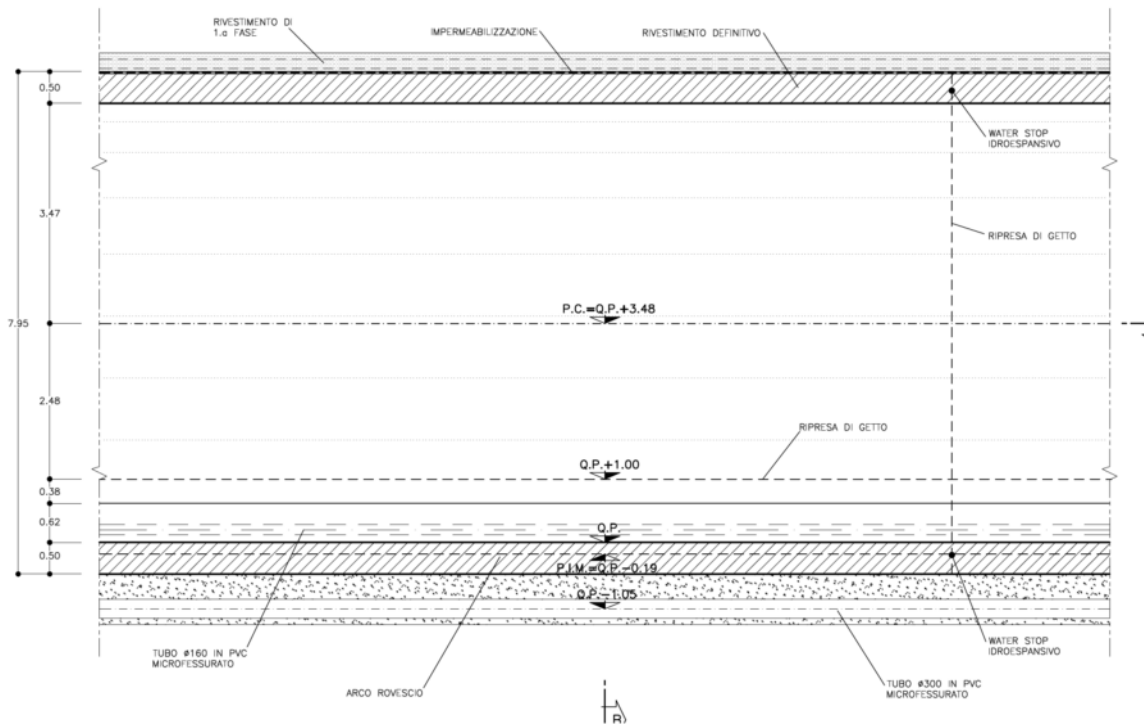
Sezione Tipo Ac – Carpenteria – Profilo longitudinale
